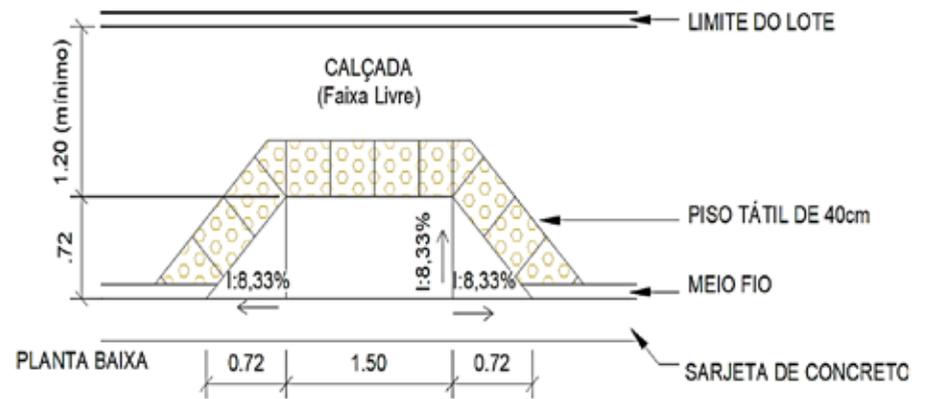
Planta baixa e corte da rampa transversal para calçada com altura de 6 cm
